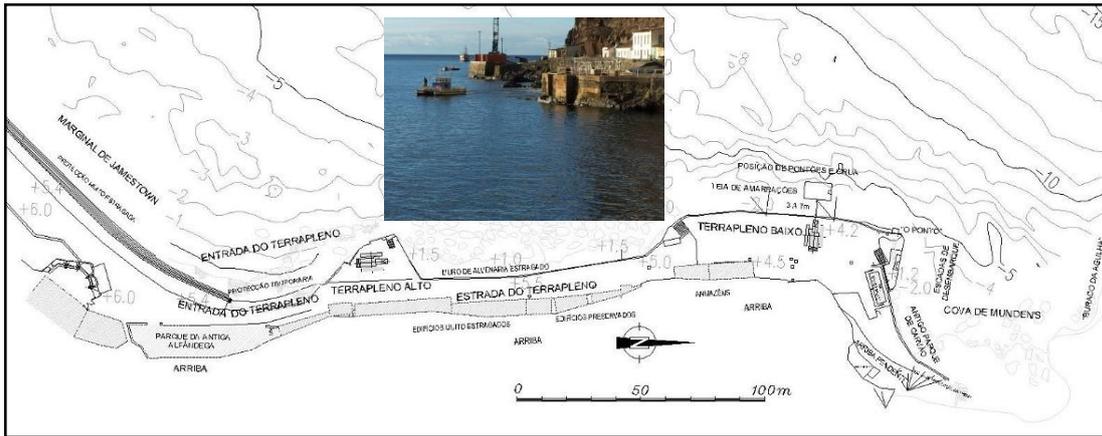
Planta da situação de referência e Catamarã usado para o levantamento hidrográfico
